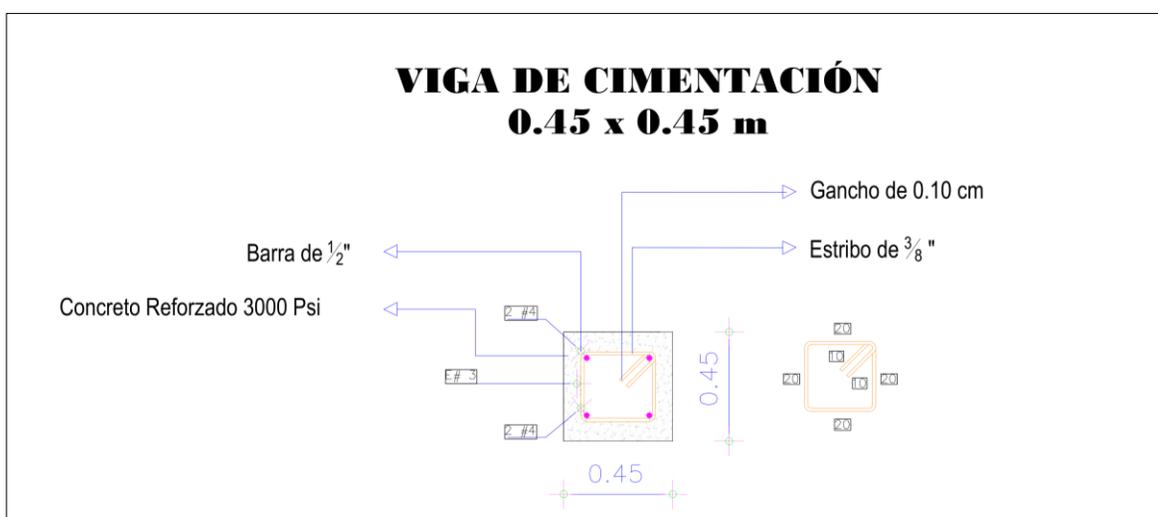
Viga de cimentación, Fuente: elaboración propia.
